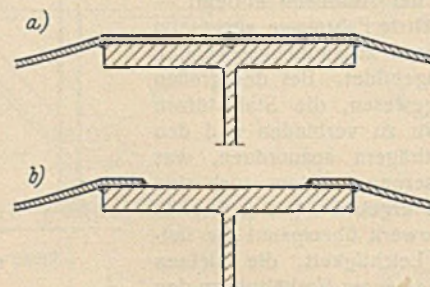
Aufschweißen der Tonnenbleche.
